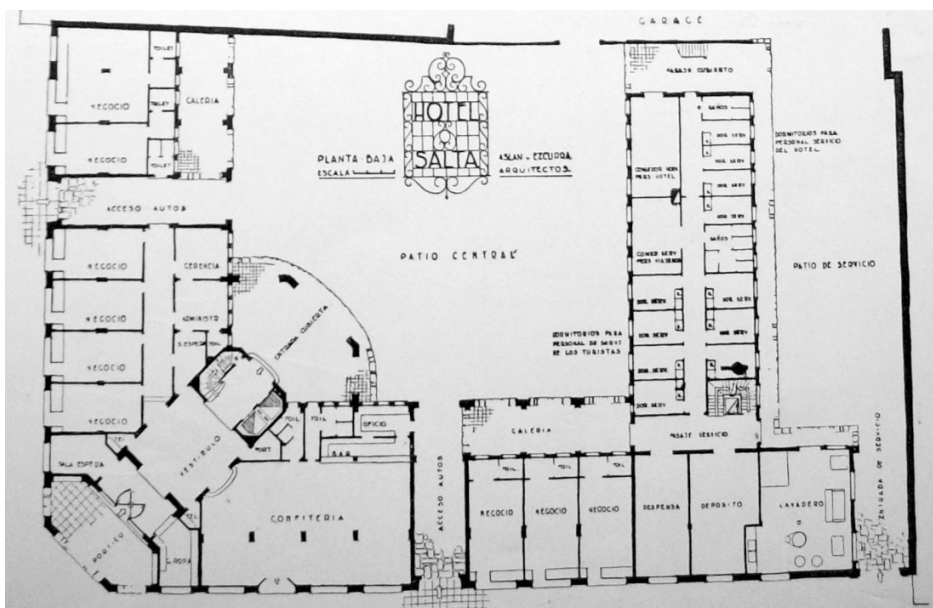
Plano planta baja hotel Salta. (Revista de Arquitectura, 225)
